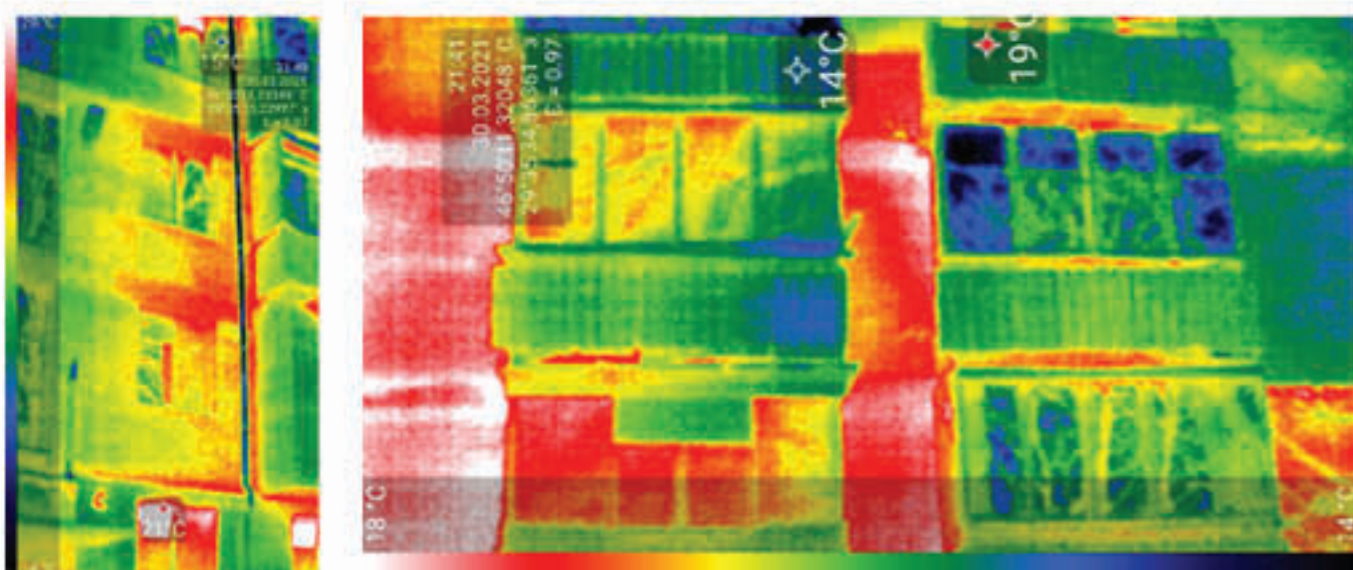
Тепловизионное обследование здания в 5 этажей г. Тирасполь ул. Федько 32
